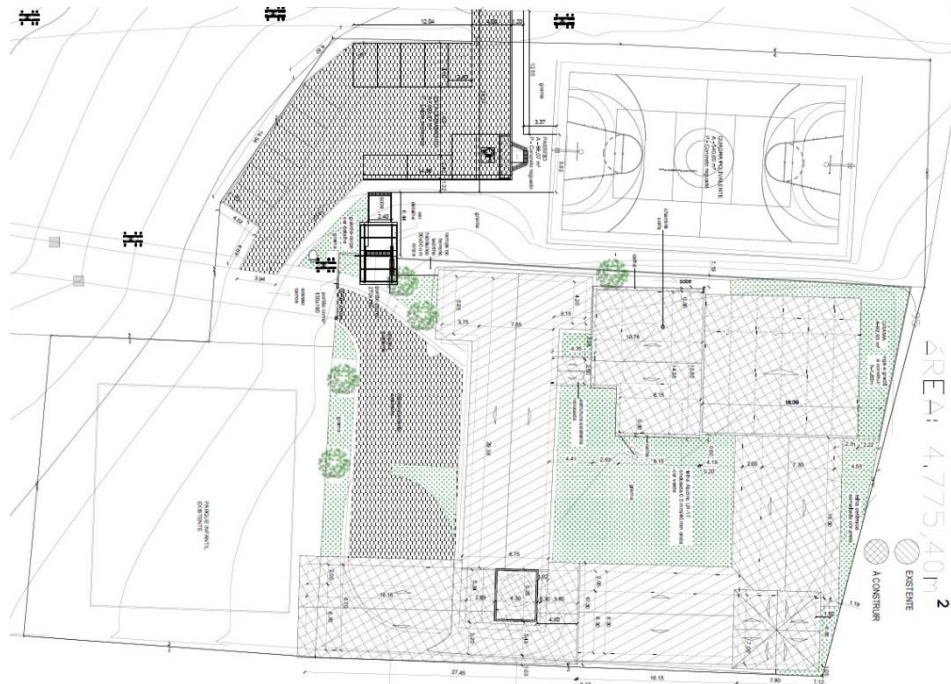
Planta de implantação da escola. (Fonte: PMC).
